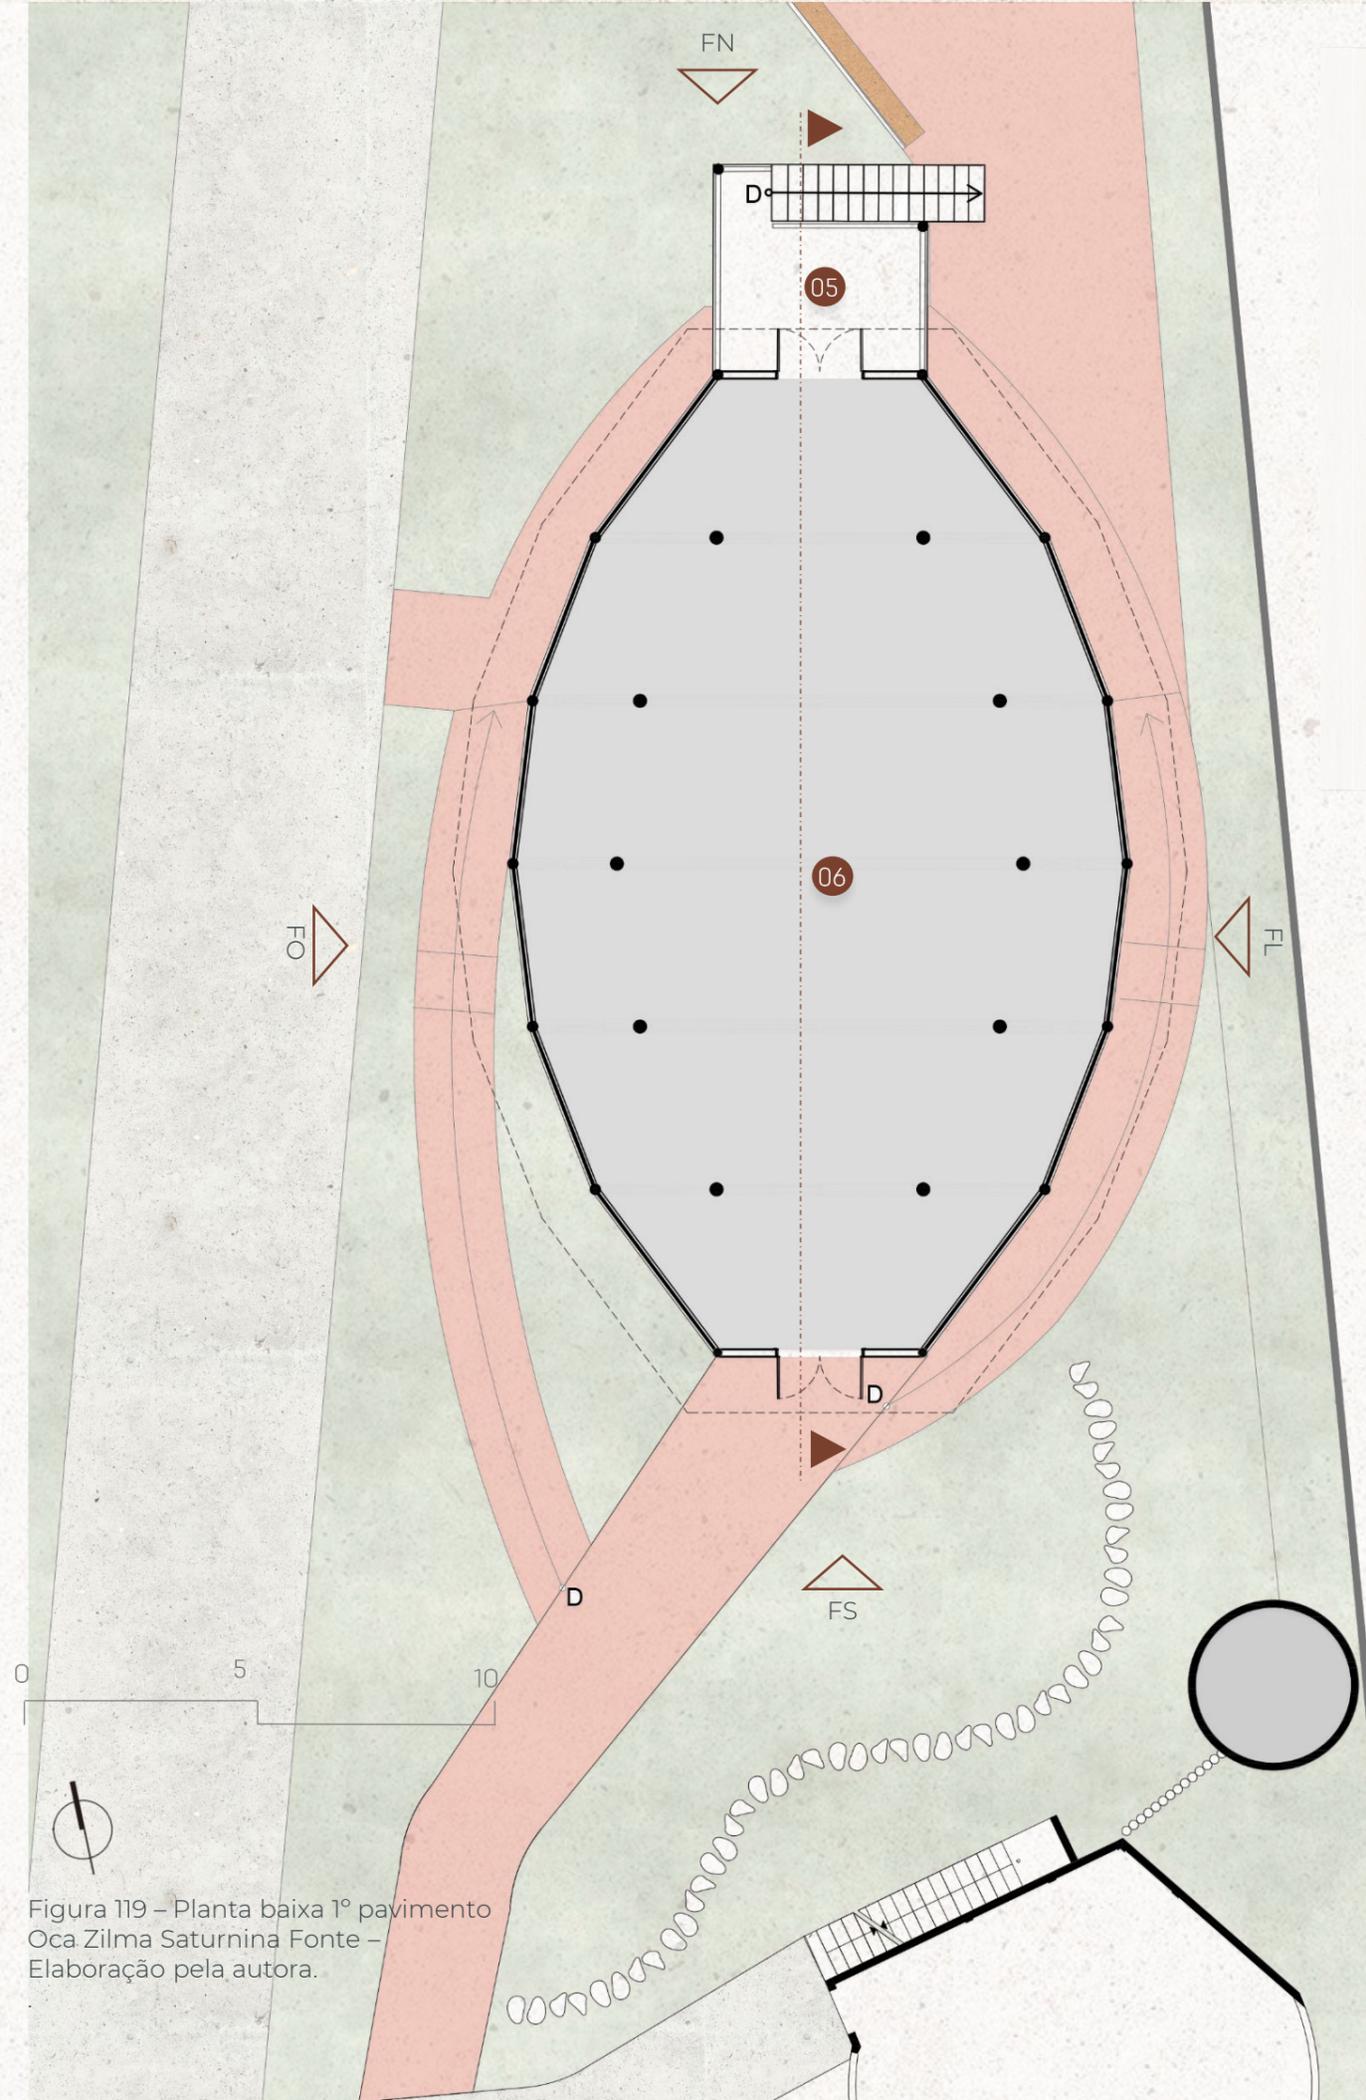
Planta baixa 1º pavimento Oca Zilma Saturnina Fonte –
